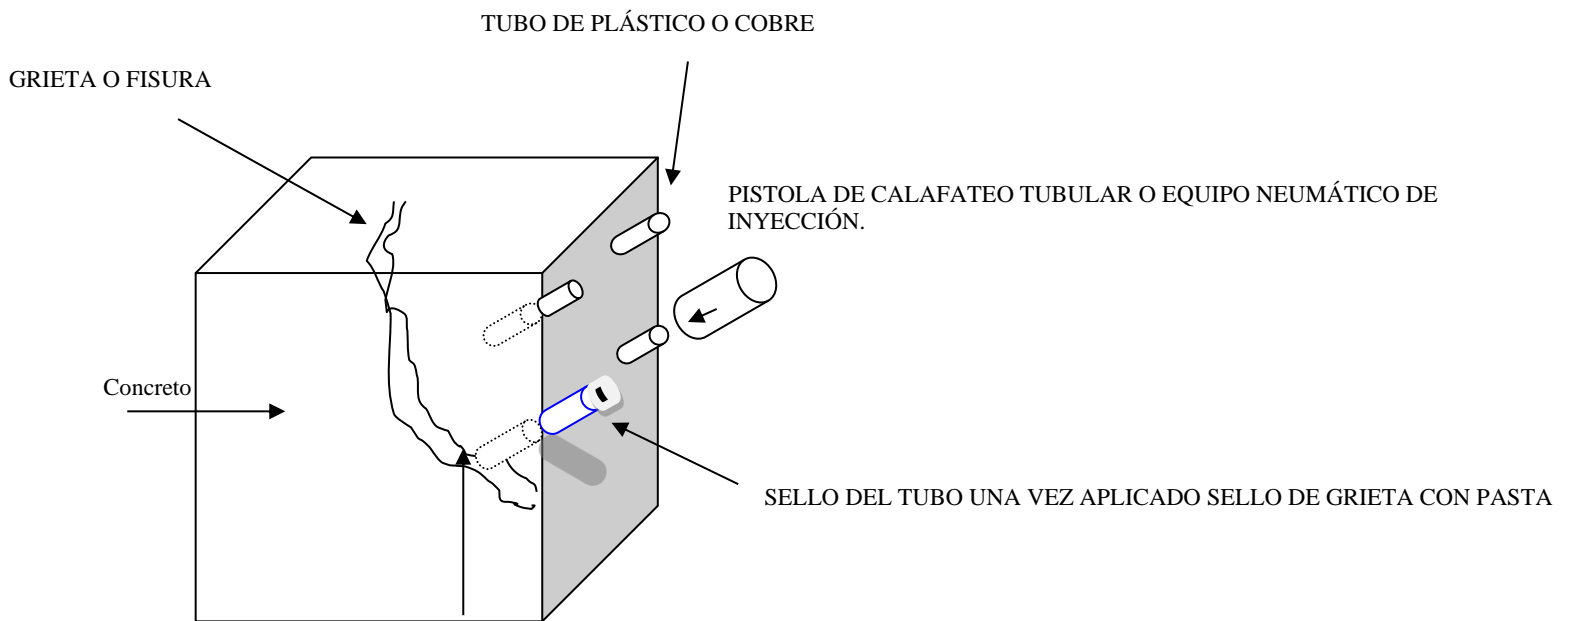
Fig. B SELLADO DE GRIETAS E INYECCIÓN DEL SISTEMA EPÓXICO
